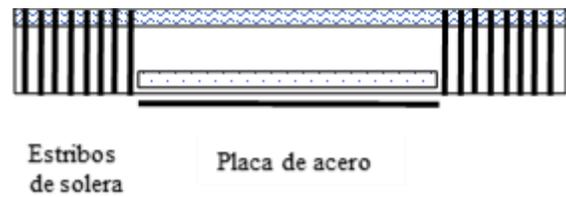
Vista del acero adicional de refuerzo en la nervadura
